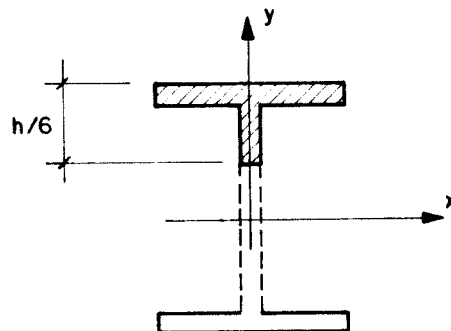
Perfil estrutural para o cálculo do raio de giração  $r_T$
